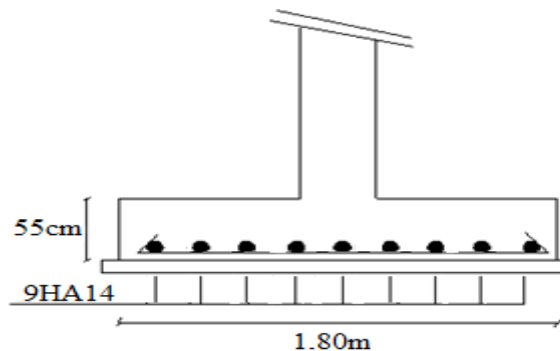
Ferrailage de la semelle intermédiaire dans le sens x-x.
